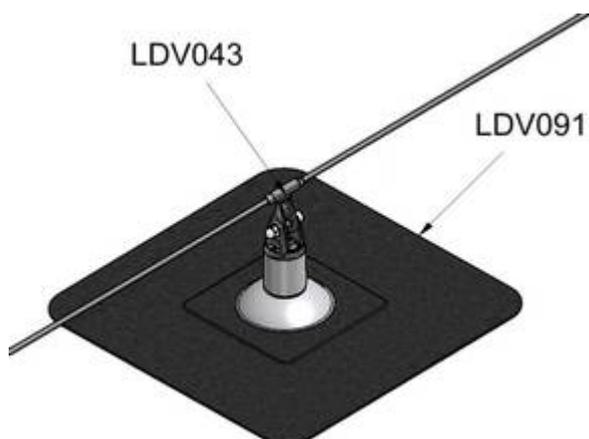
Montage ancre intermédiaire sur Spotanchor
